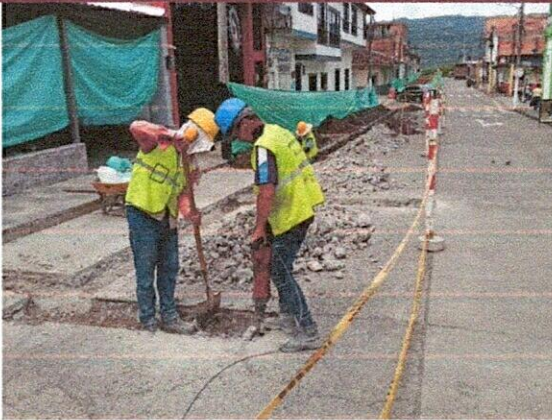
y 3: Daño en tubería existente por mal estado de esta.
